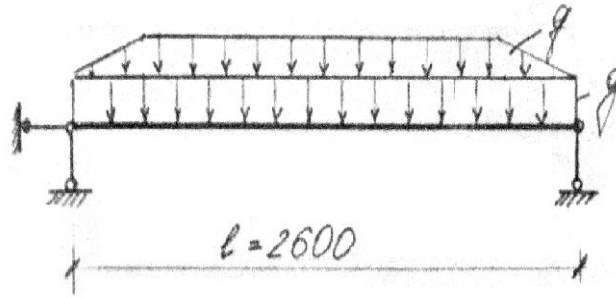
Розрахункова схема ребра сходового майданчика
